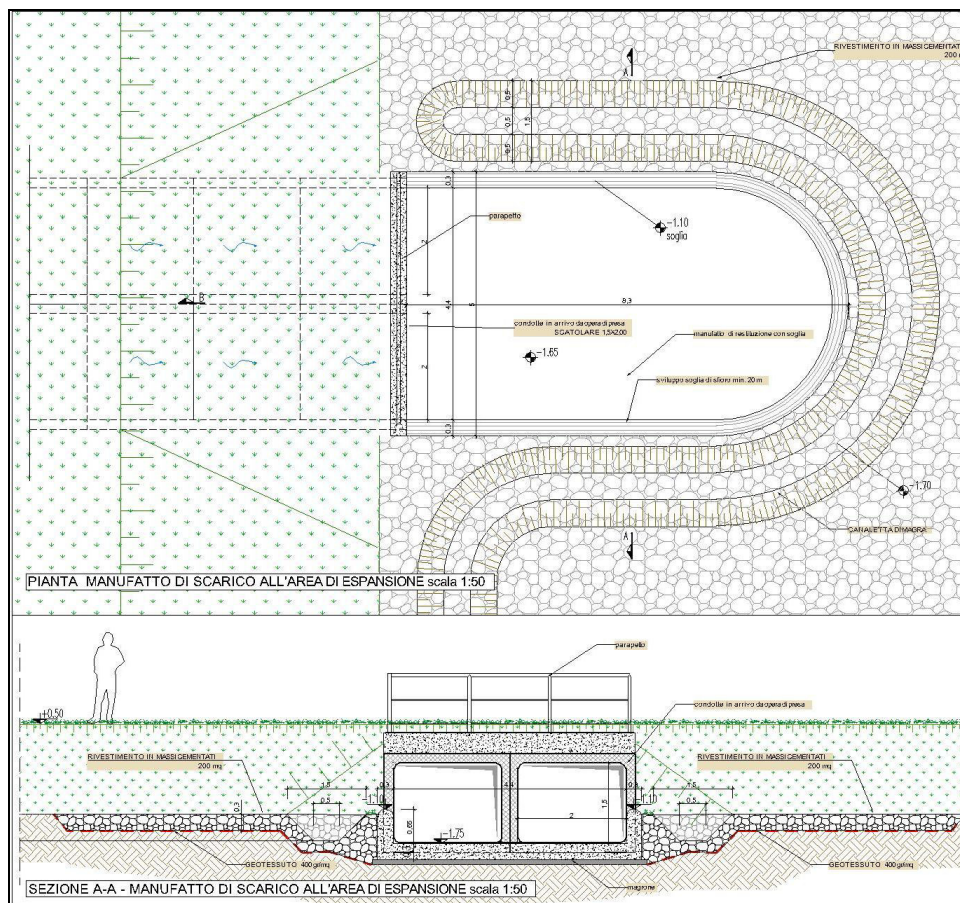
pianta e sezione dell'opera di restituzione al bacino di espansione
